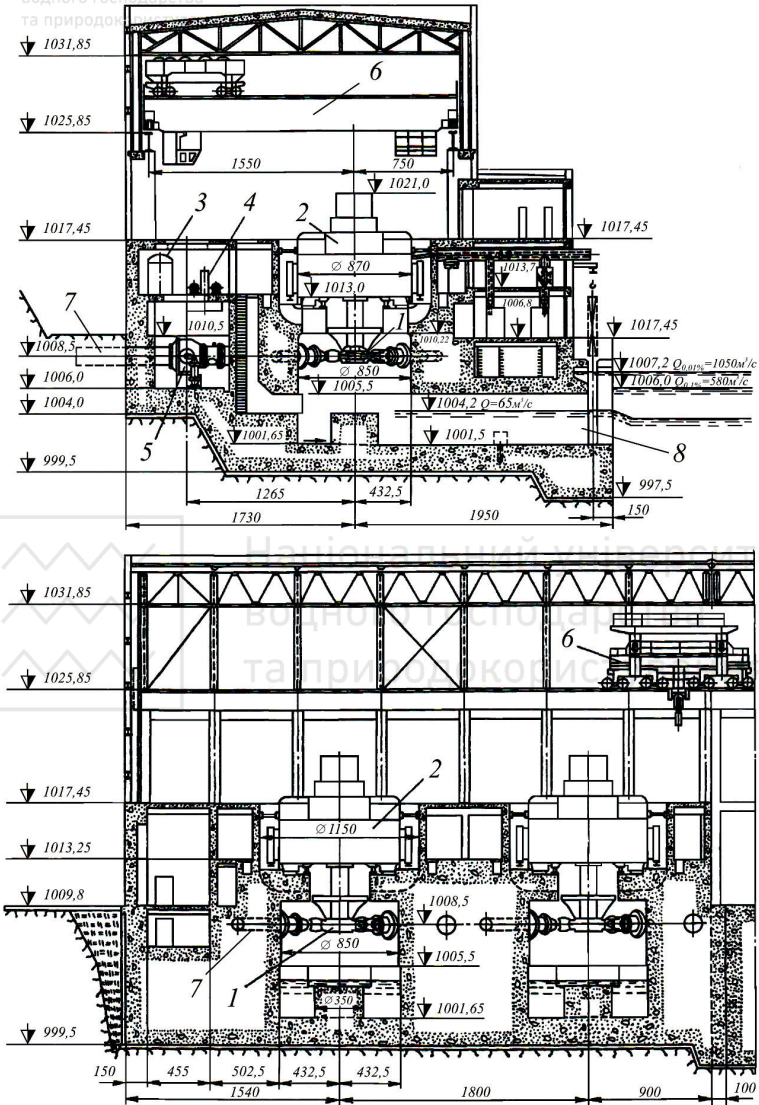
Поперечний і поздовжній перерізи будівлі дериваційної ГЕС:
